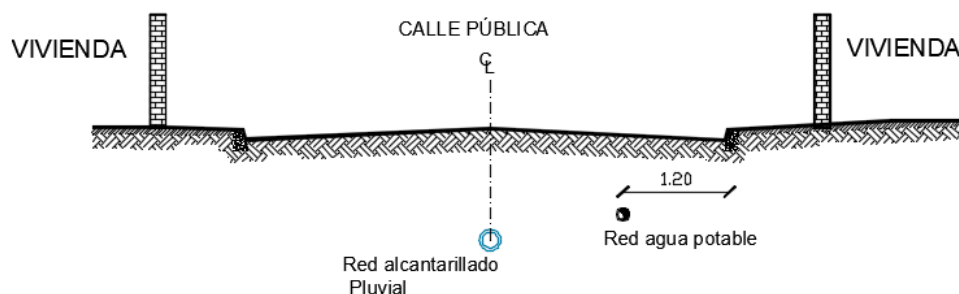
Ubicación red de alcantarillado pluvial en elevación
